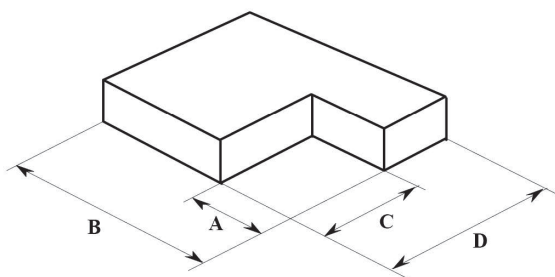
Irregularidad en planta por desplazamiento de los planos de acción.
